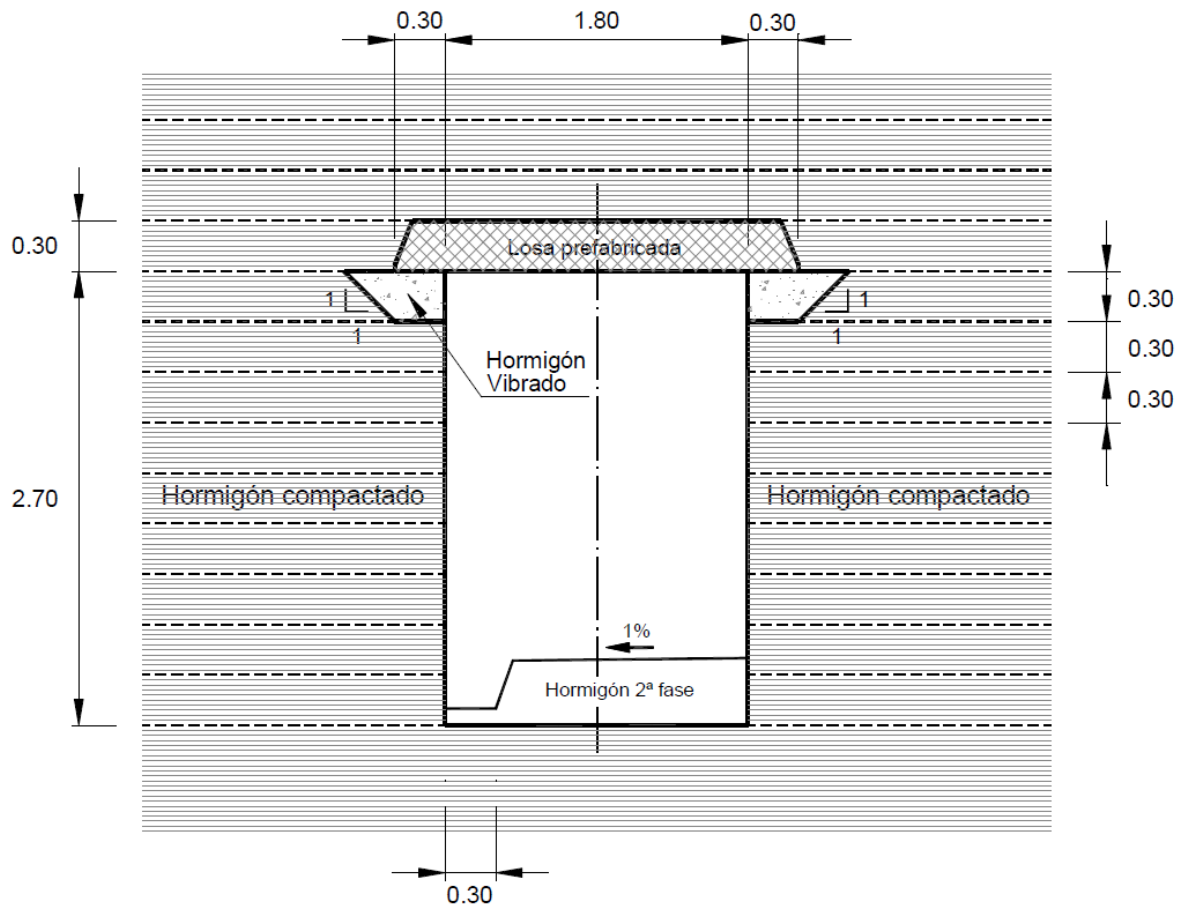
Sección tipo de galería con losa prefabricada en clave.
